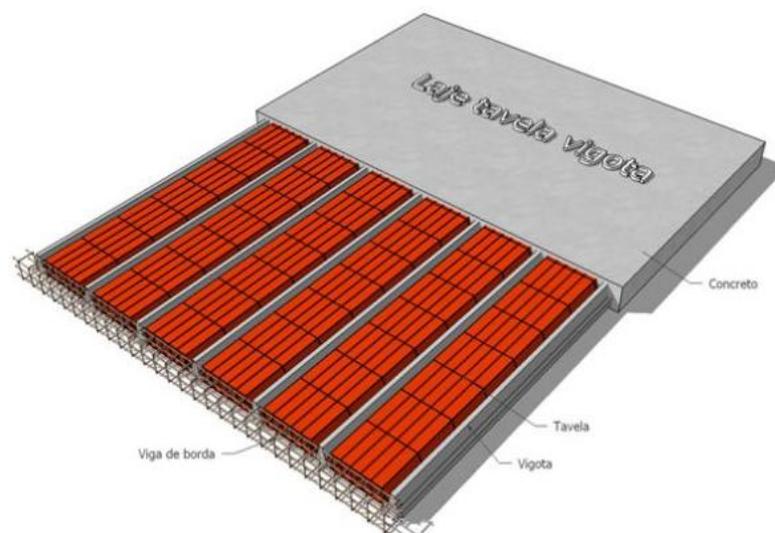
Dimensionamento de Lajes Pré-Fabricadas: vigota e tavela
